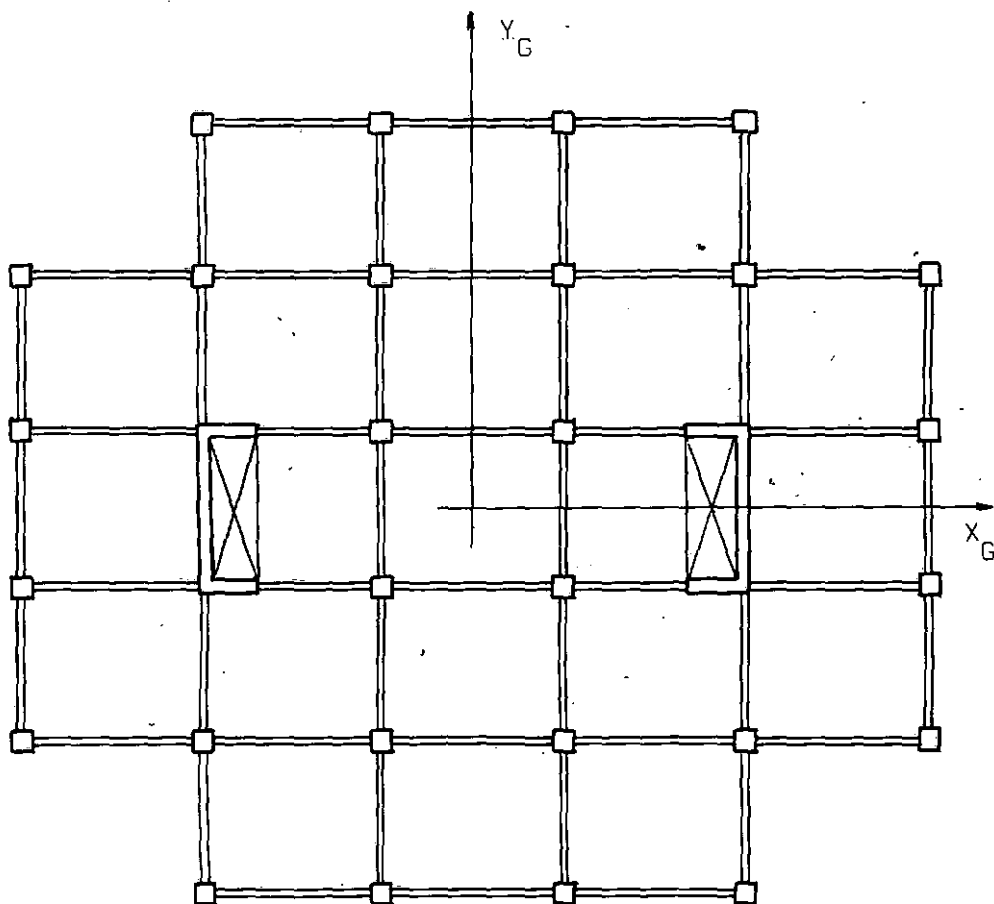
Esquema do pavimento tipo utilizado na série de exemplos 4
